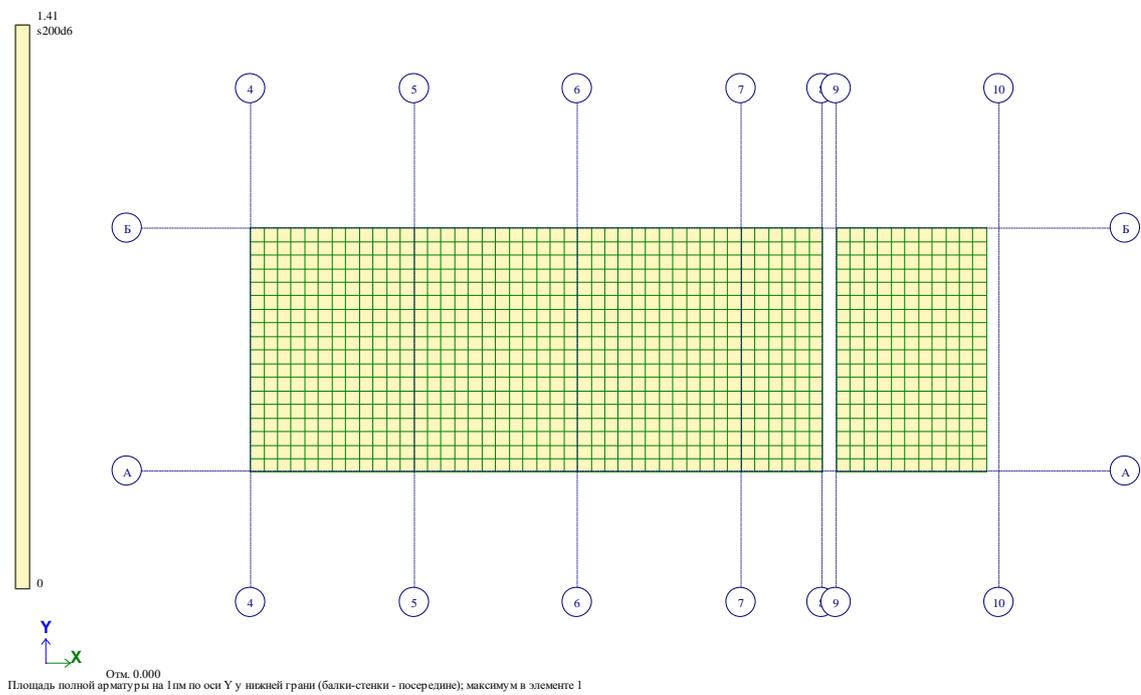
Требуемая площадь нижнего армирования по оси Y
